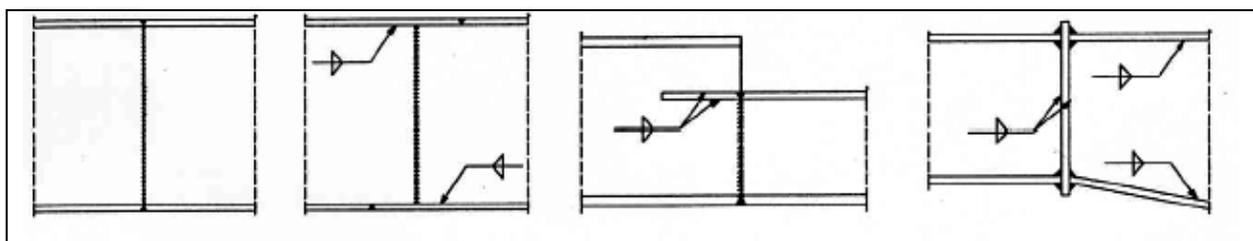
Geschweißter Trägerstoß, Ausführungsformen, aus [25]
